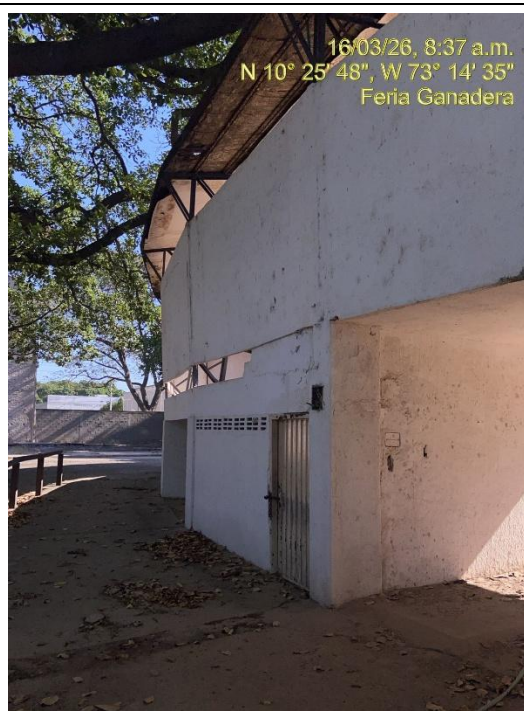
Acabados exteriores Coliseo Pedro Castro. Zona 2. Fuente: Propia.
